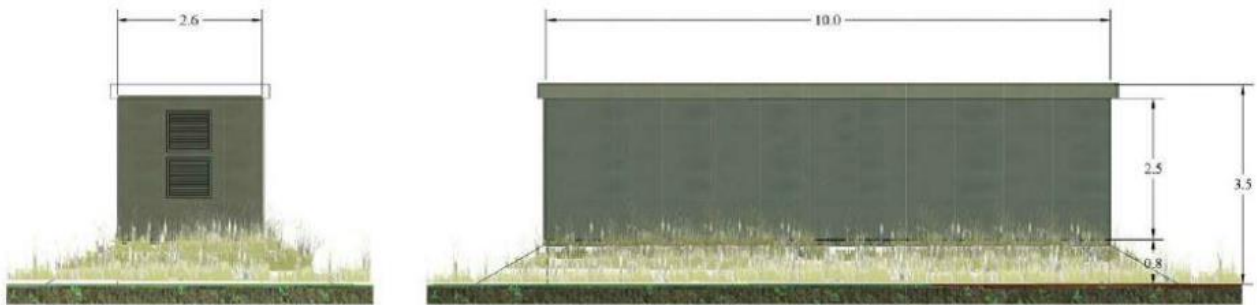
Plan de coupe et façades d'un poste de livraison – Source : Étude d'impact
